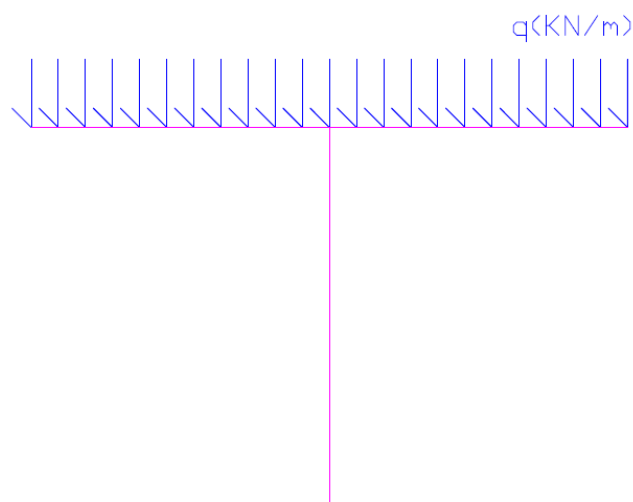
Esquema geral de aplicação da carga vertical, no modelo de pórtico.
